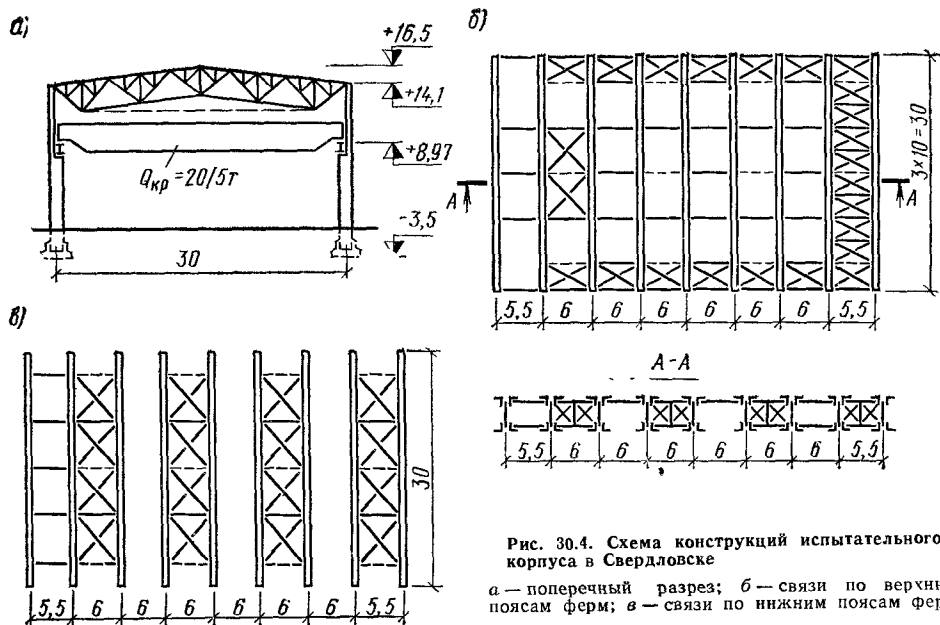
Схема конструкций испытательного корпуса в Свердловске
